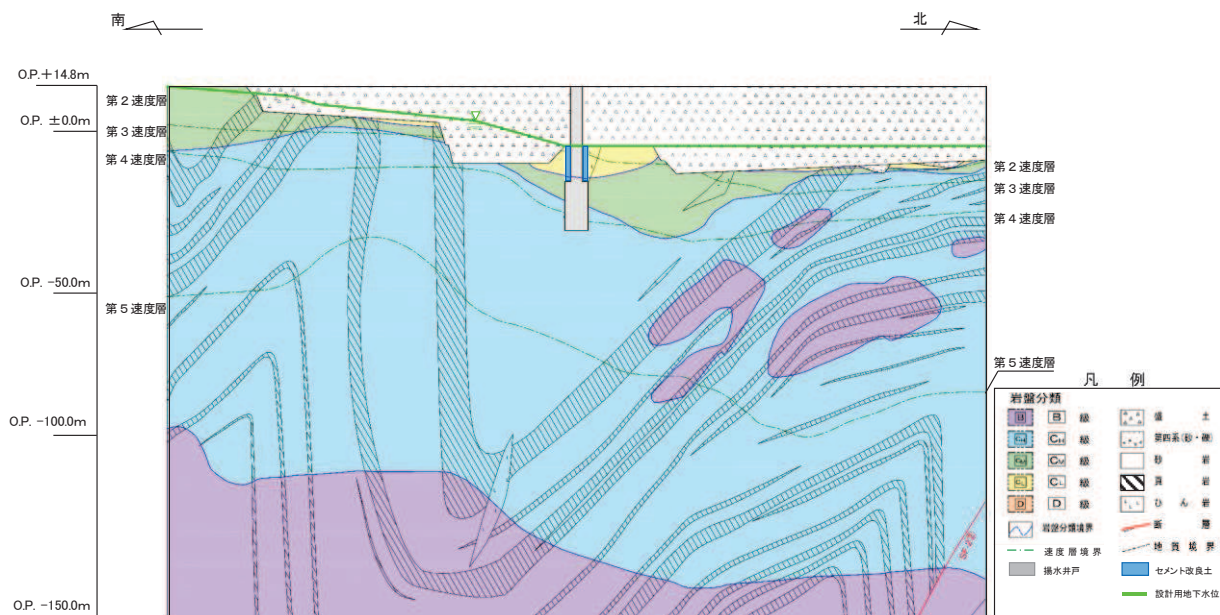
(1) No.1 揚水井戸 評価対象断面図 (A' -A 断面)
